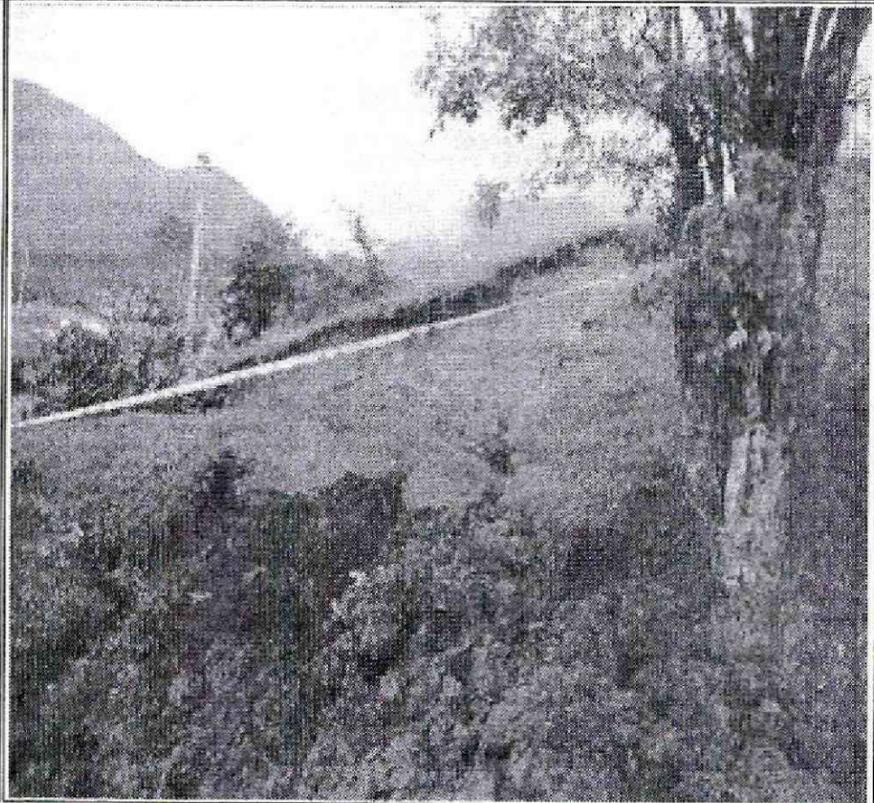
Grietas en el talud rocoso sobre el Costado Sur del predio de la Calle 1 No. 1 A – 30 Barrio Buenos Aires
